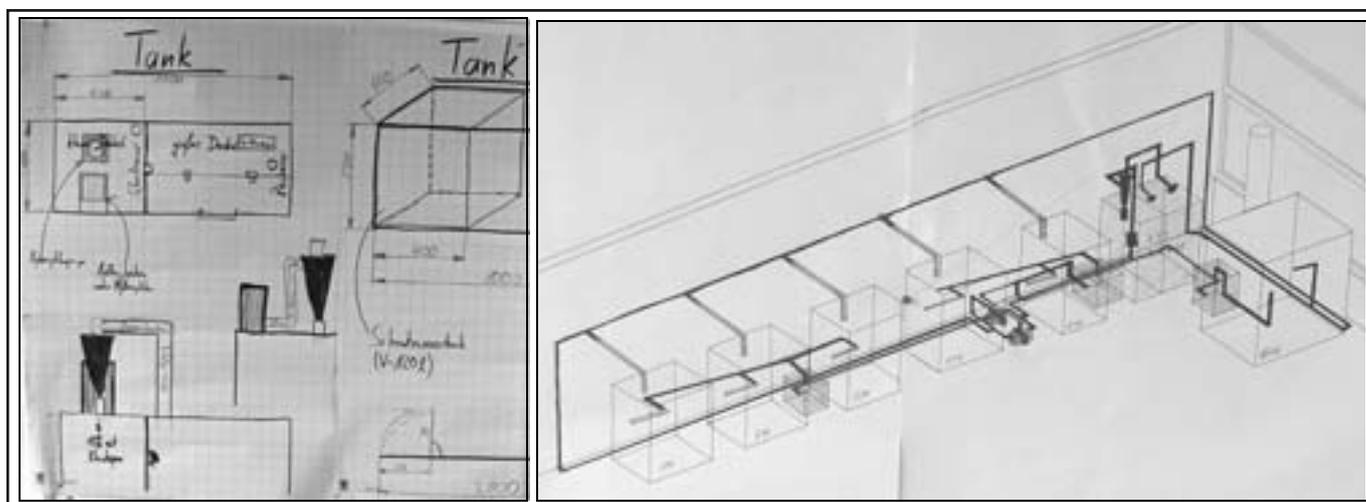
Von den Lernenden erstellte Planungsunterlagen
